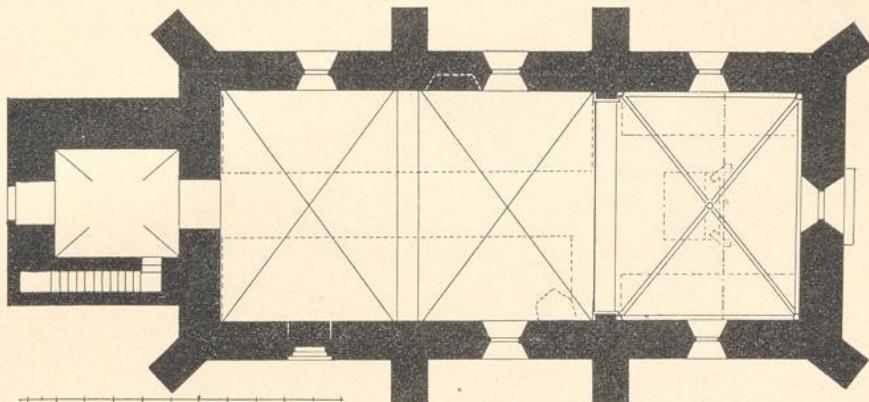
Kirche in Üffeln; Grundriss (1:250).
